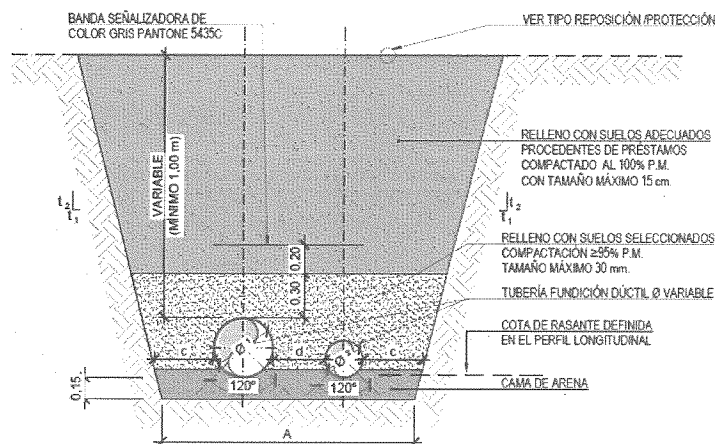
SECCIÓN TIPO D. ZANJA COMPUESTA
